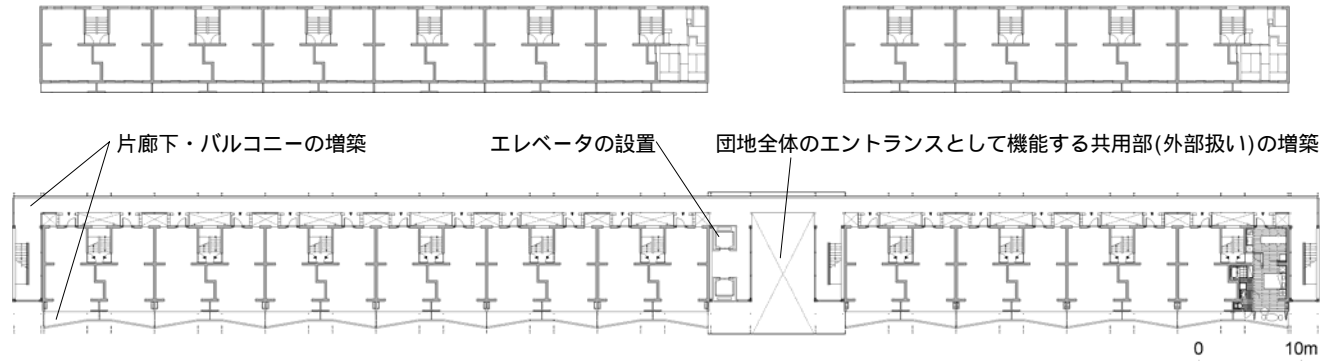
既存の住棟平面図(上)と片廊下・エレベータ設置後の住棟平面図(下)
